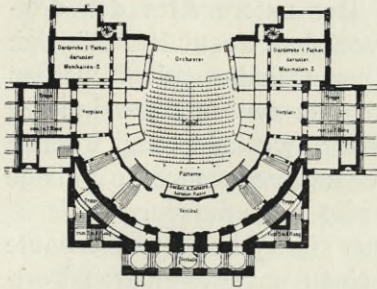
Stadttheater zu Leipzig. Grundriß des Zuschauerhauses.<sup>44)</sup>
